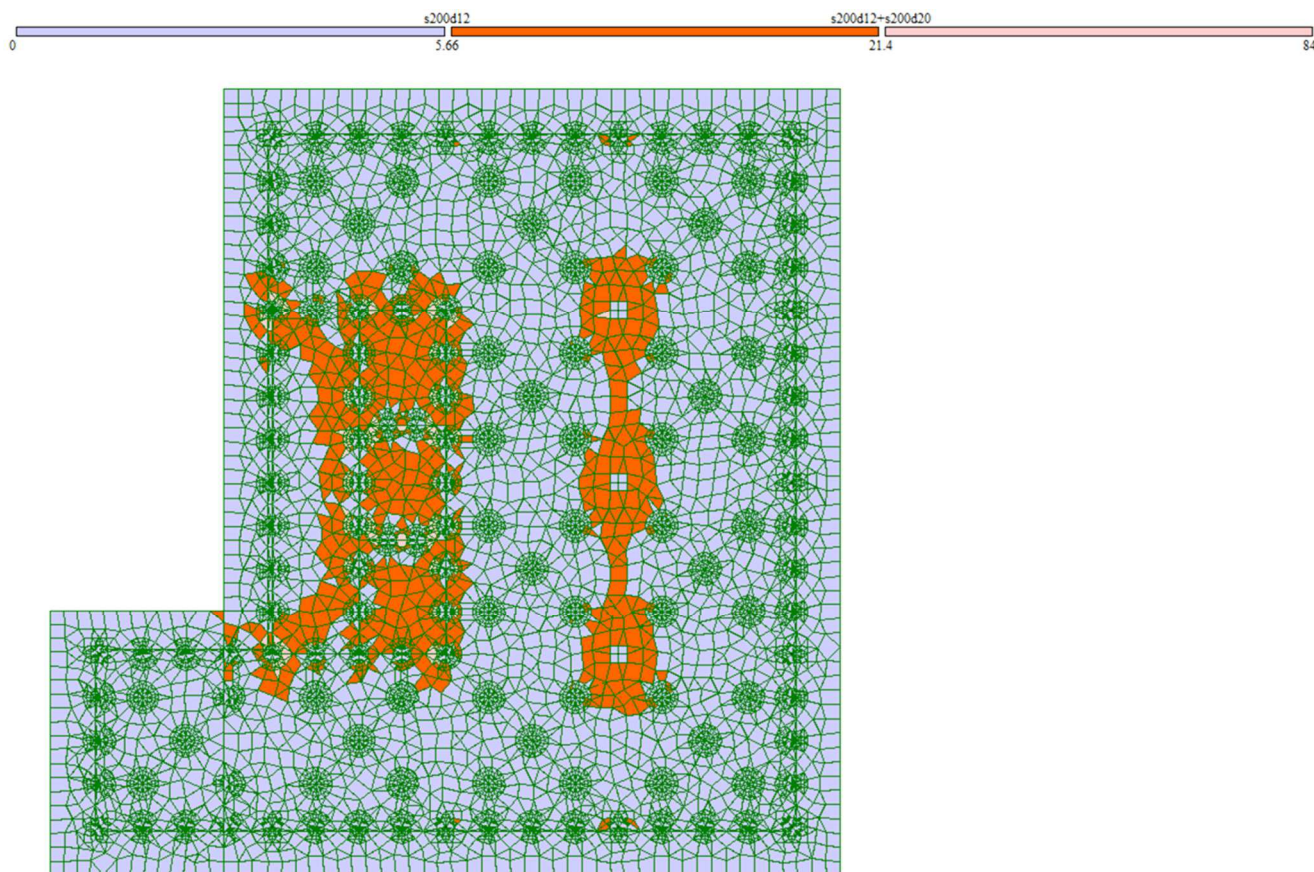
Нижнее армирование фундаментной плиты по направлению x
